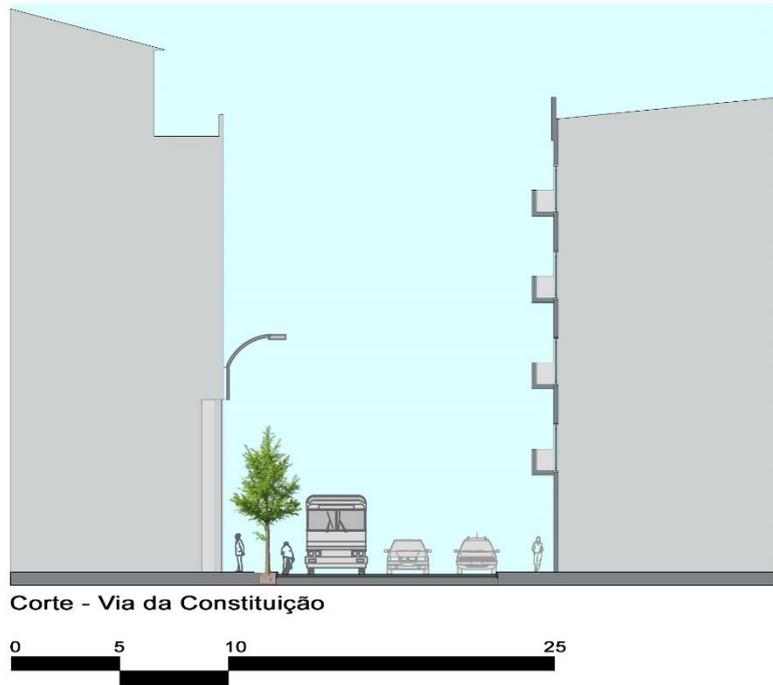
Rua da Constituição, corte demonstrando a proposta do Guia.
